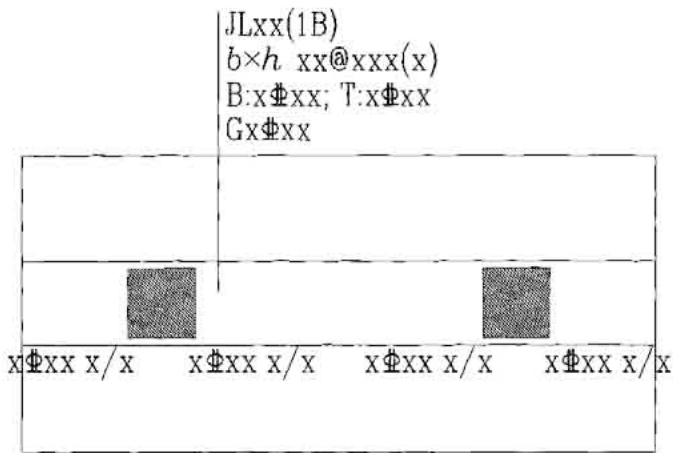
双柱独立基础的基础梁配筋注写示意
